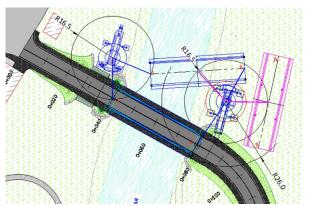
Planta con planificación de maniobra (posicionamiento de grúas).
